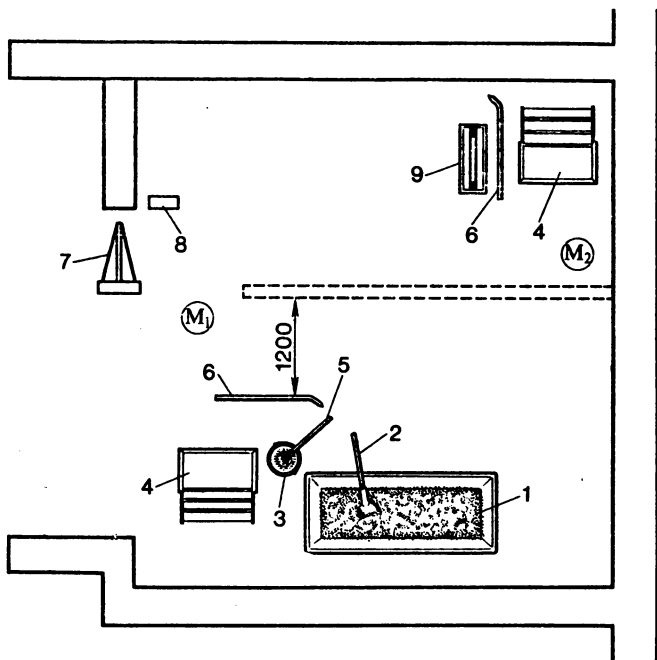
Схема организации рабочего места монтажников панельных перегородок:
